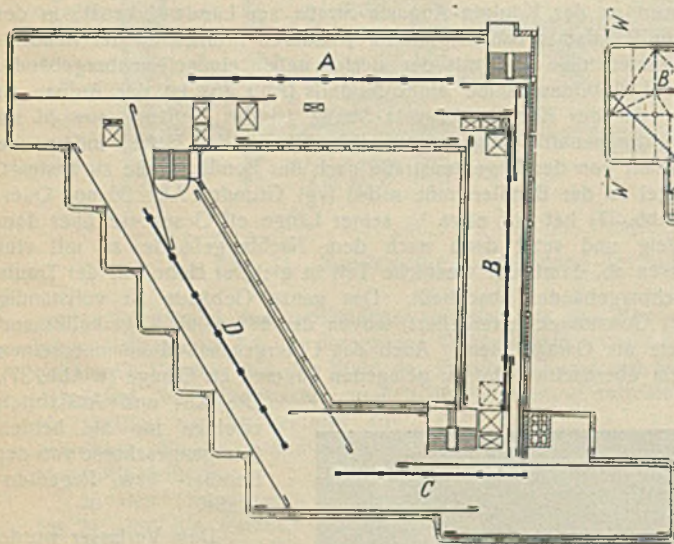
Bewehrung der Geschosßdecken zur Übertragung der Windkräfte auf die Rahmenebenen A, B, C und D.
